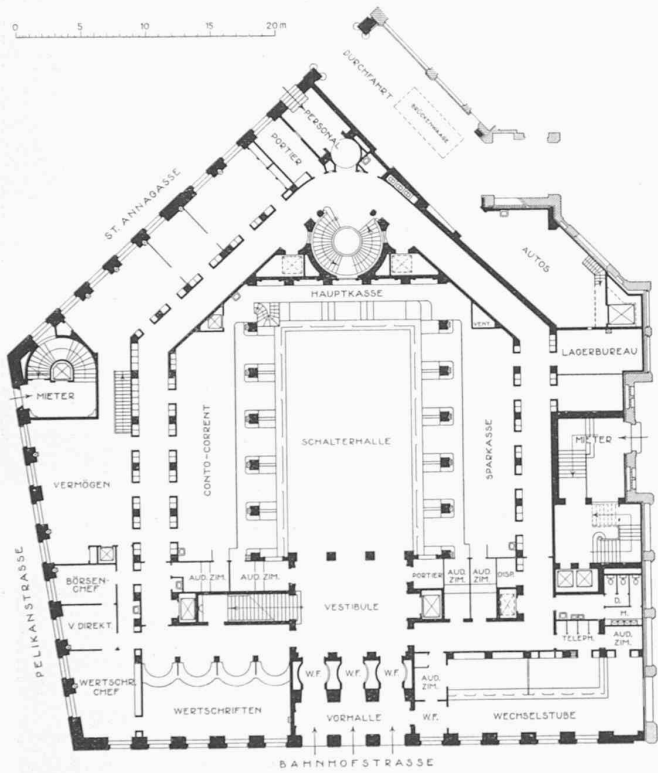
Grundriss vom Erdgeschoss.
